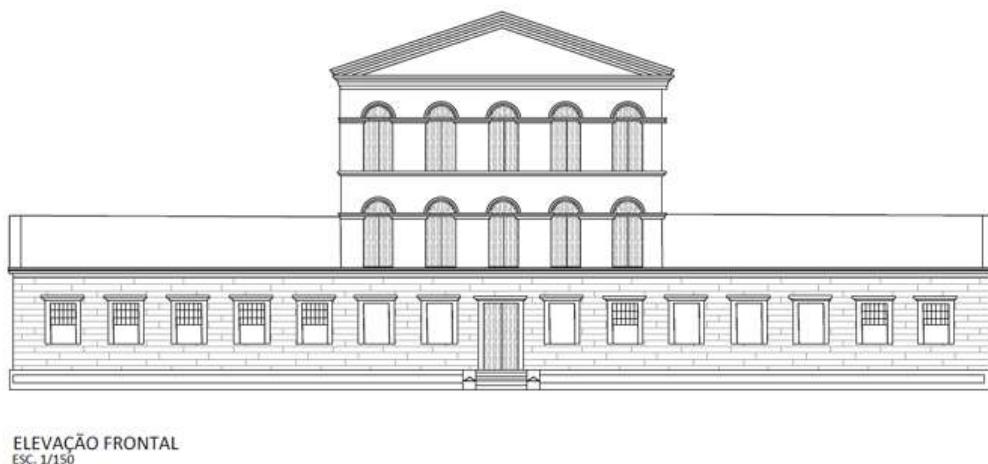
Desenho técnico das fachadas frontal (principal) da antiga cadeia. Fonte: Elaboração autoral, 2025.
